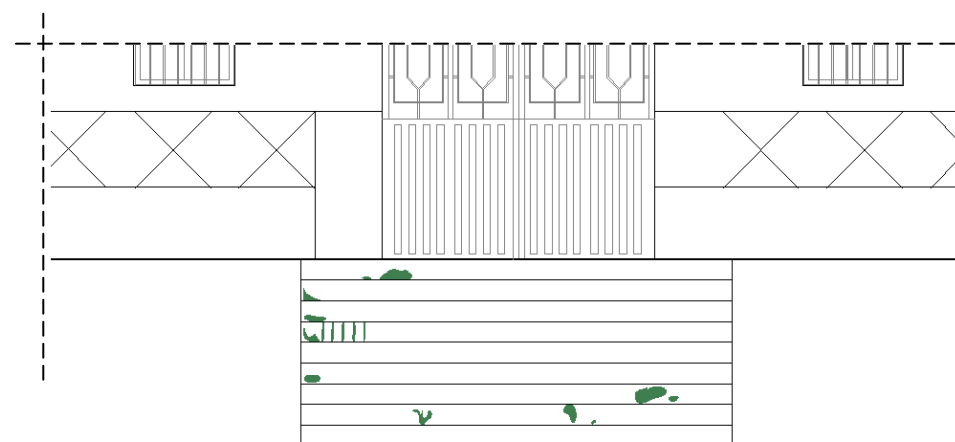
Detalle de Plano Escalera exterior (Fuente propia)
